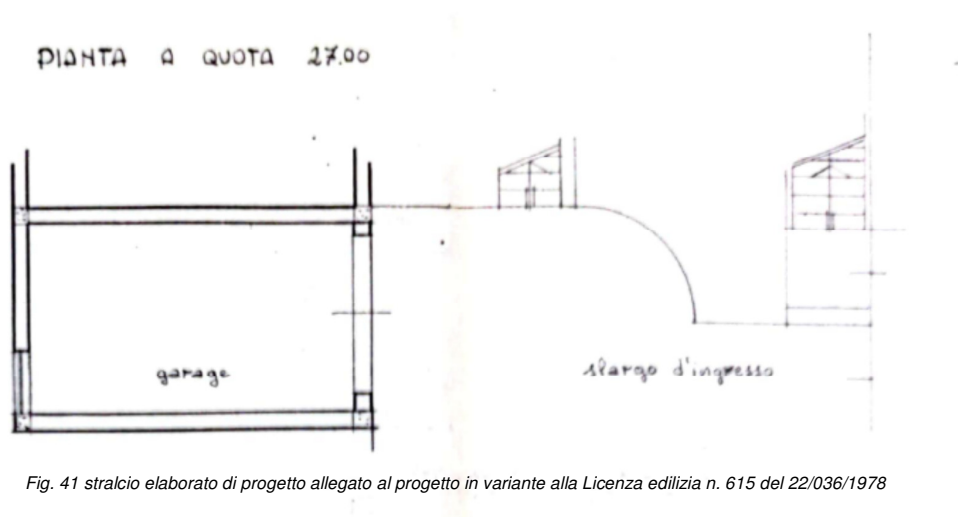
stralcio elaborato di progetto allegato al progetto in variante alla Licenza edilizia n. 615 del 22/036/1978
